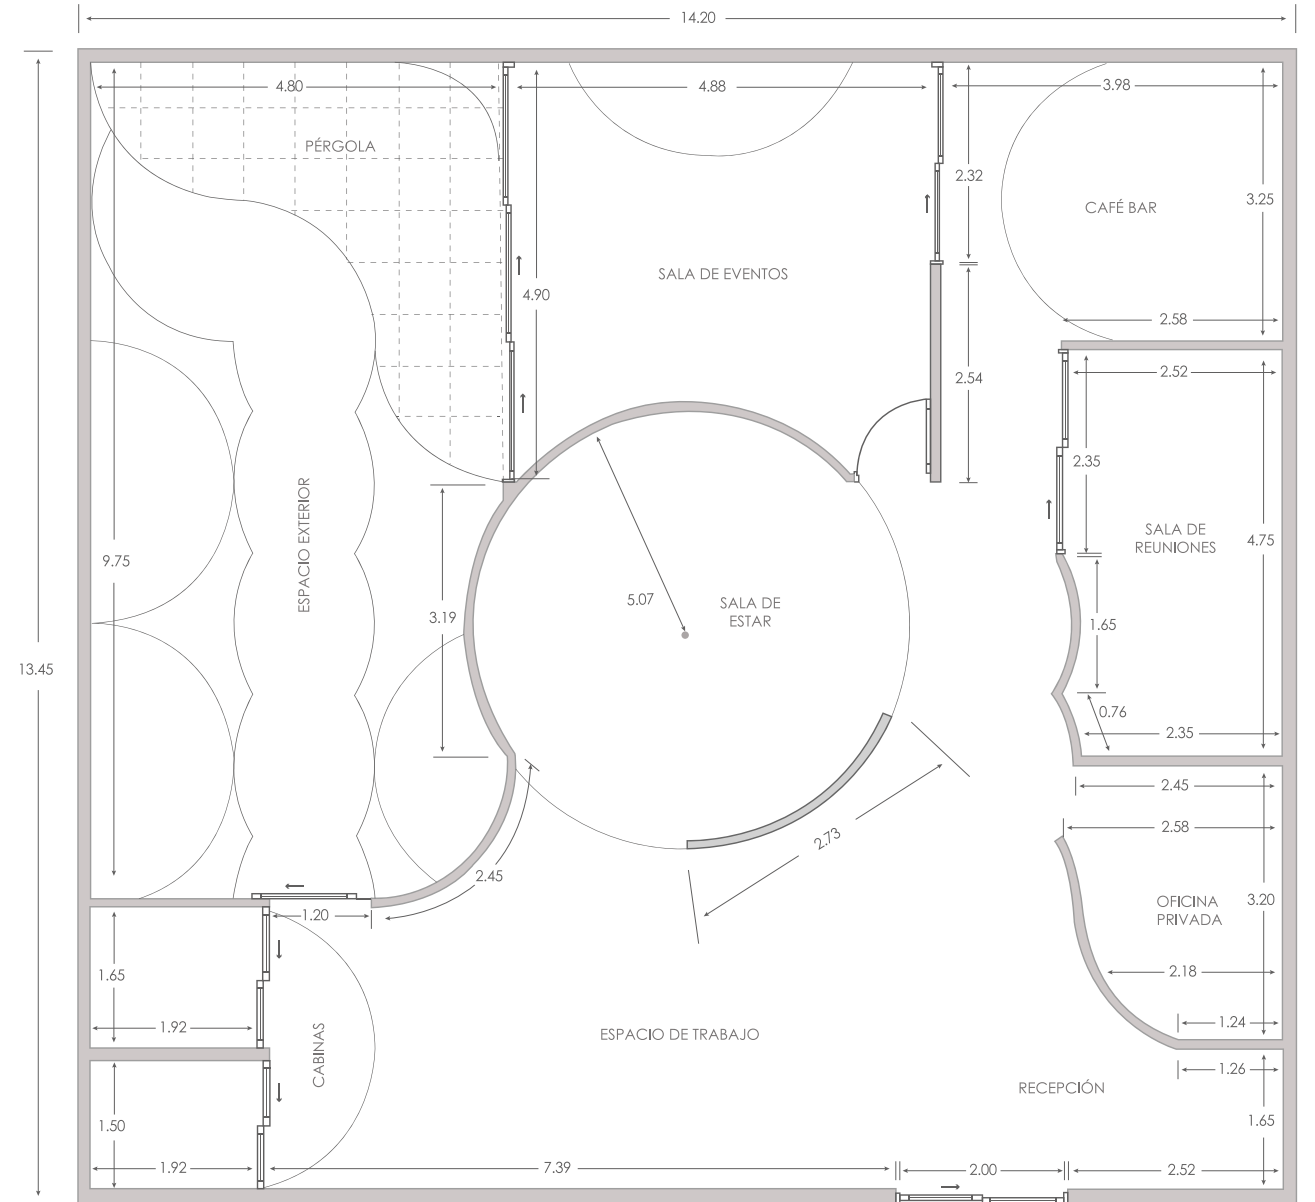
Planta de distribución. Elaboración Sharon Chavez.
